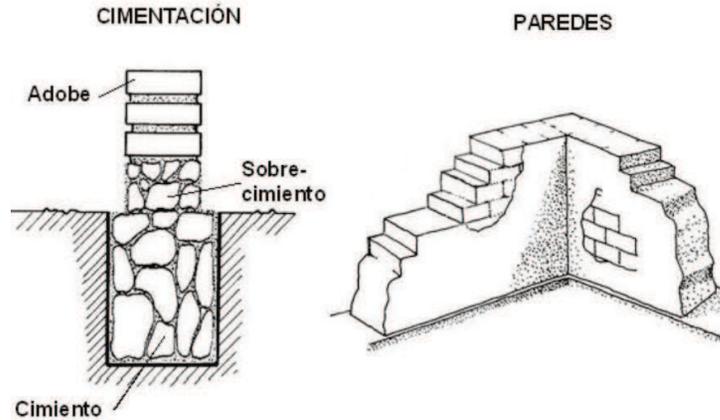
Detalles Estructurales de cimentaciones en ambos inmuebles
